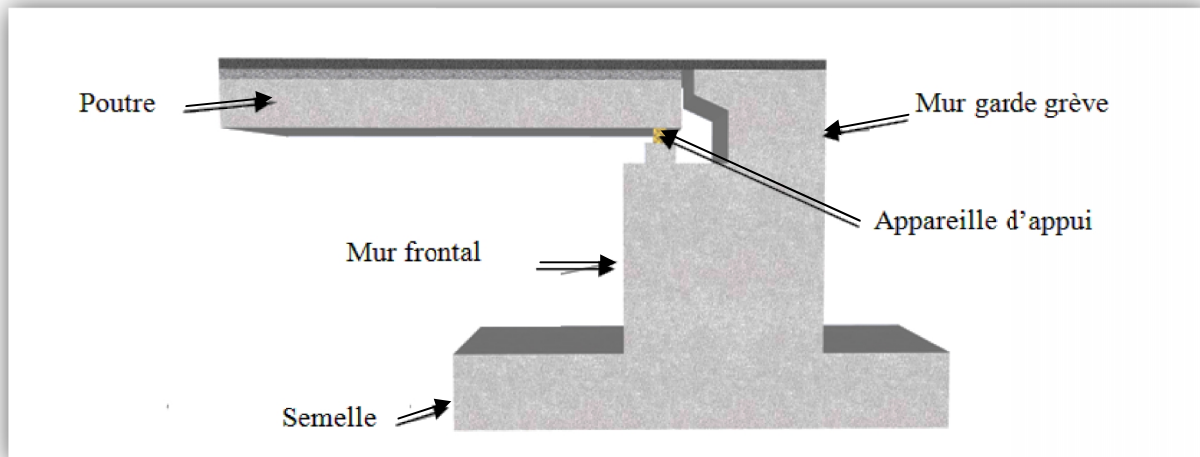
1. Coupe longitudinale d'une culée d'un pont
